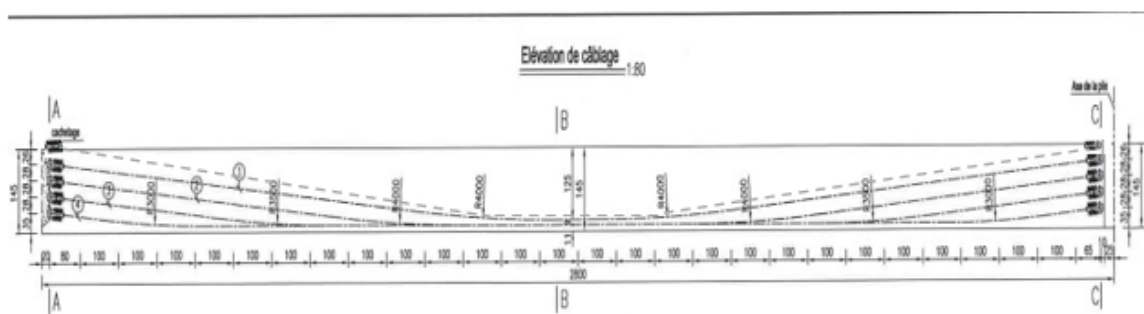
L'emplacement des câbles dans les sections de poutres (coupe longitudinale)
